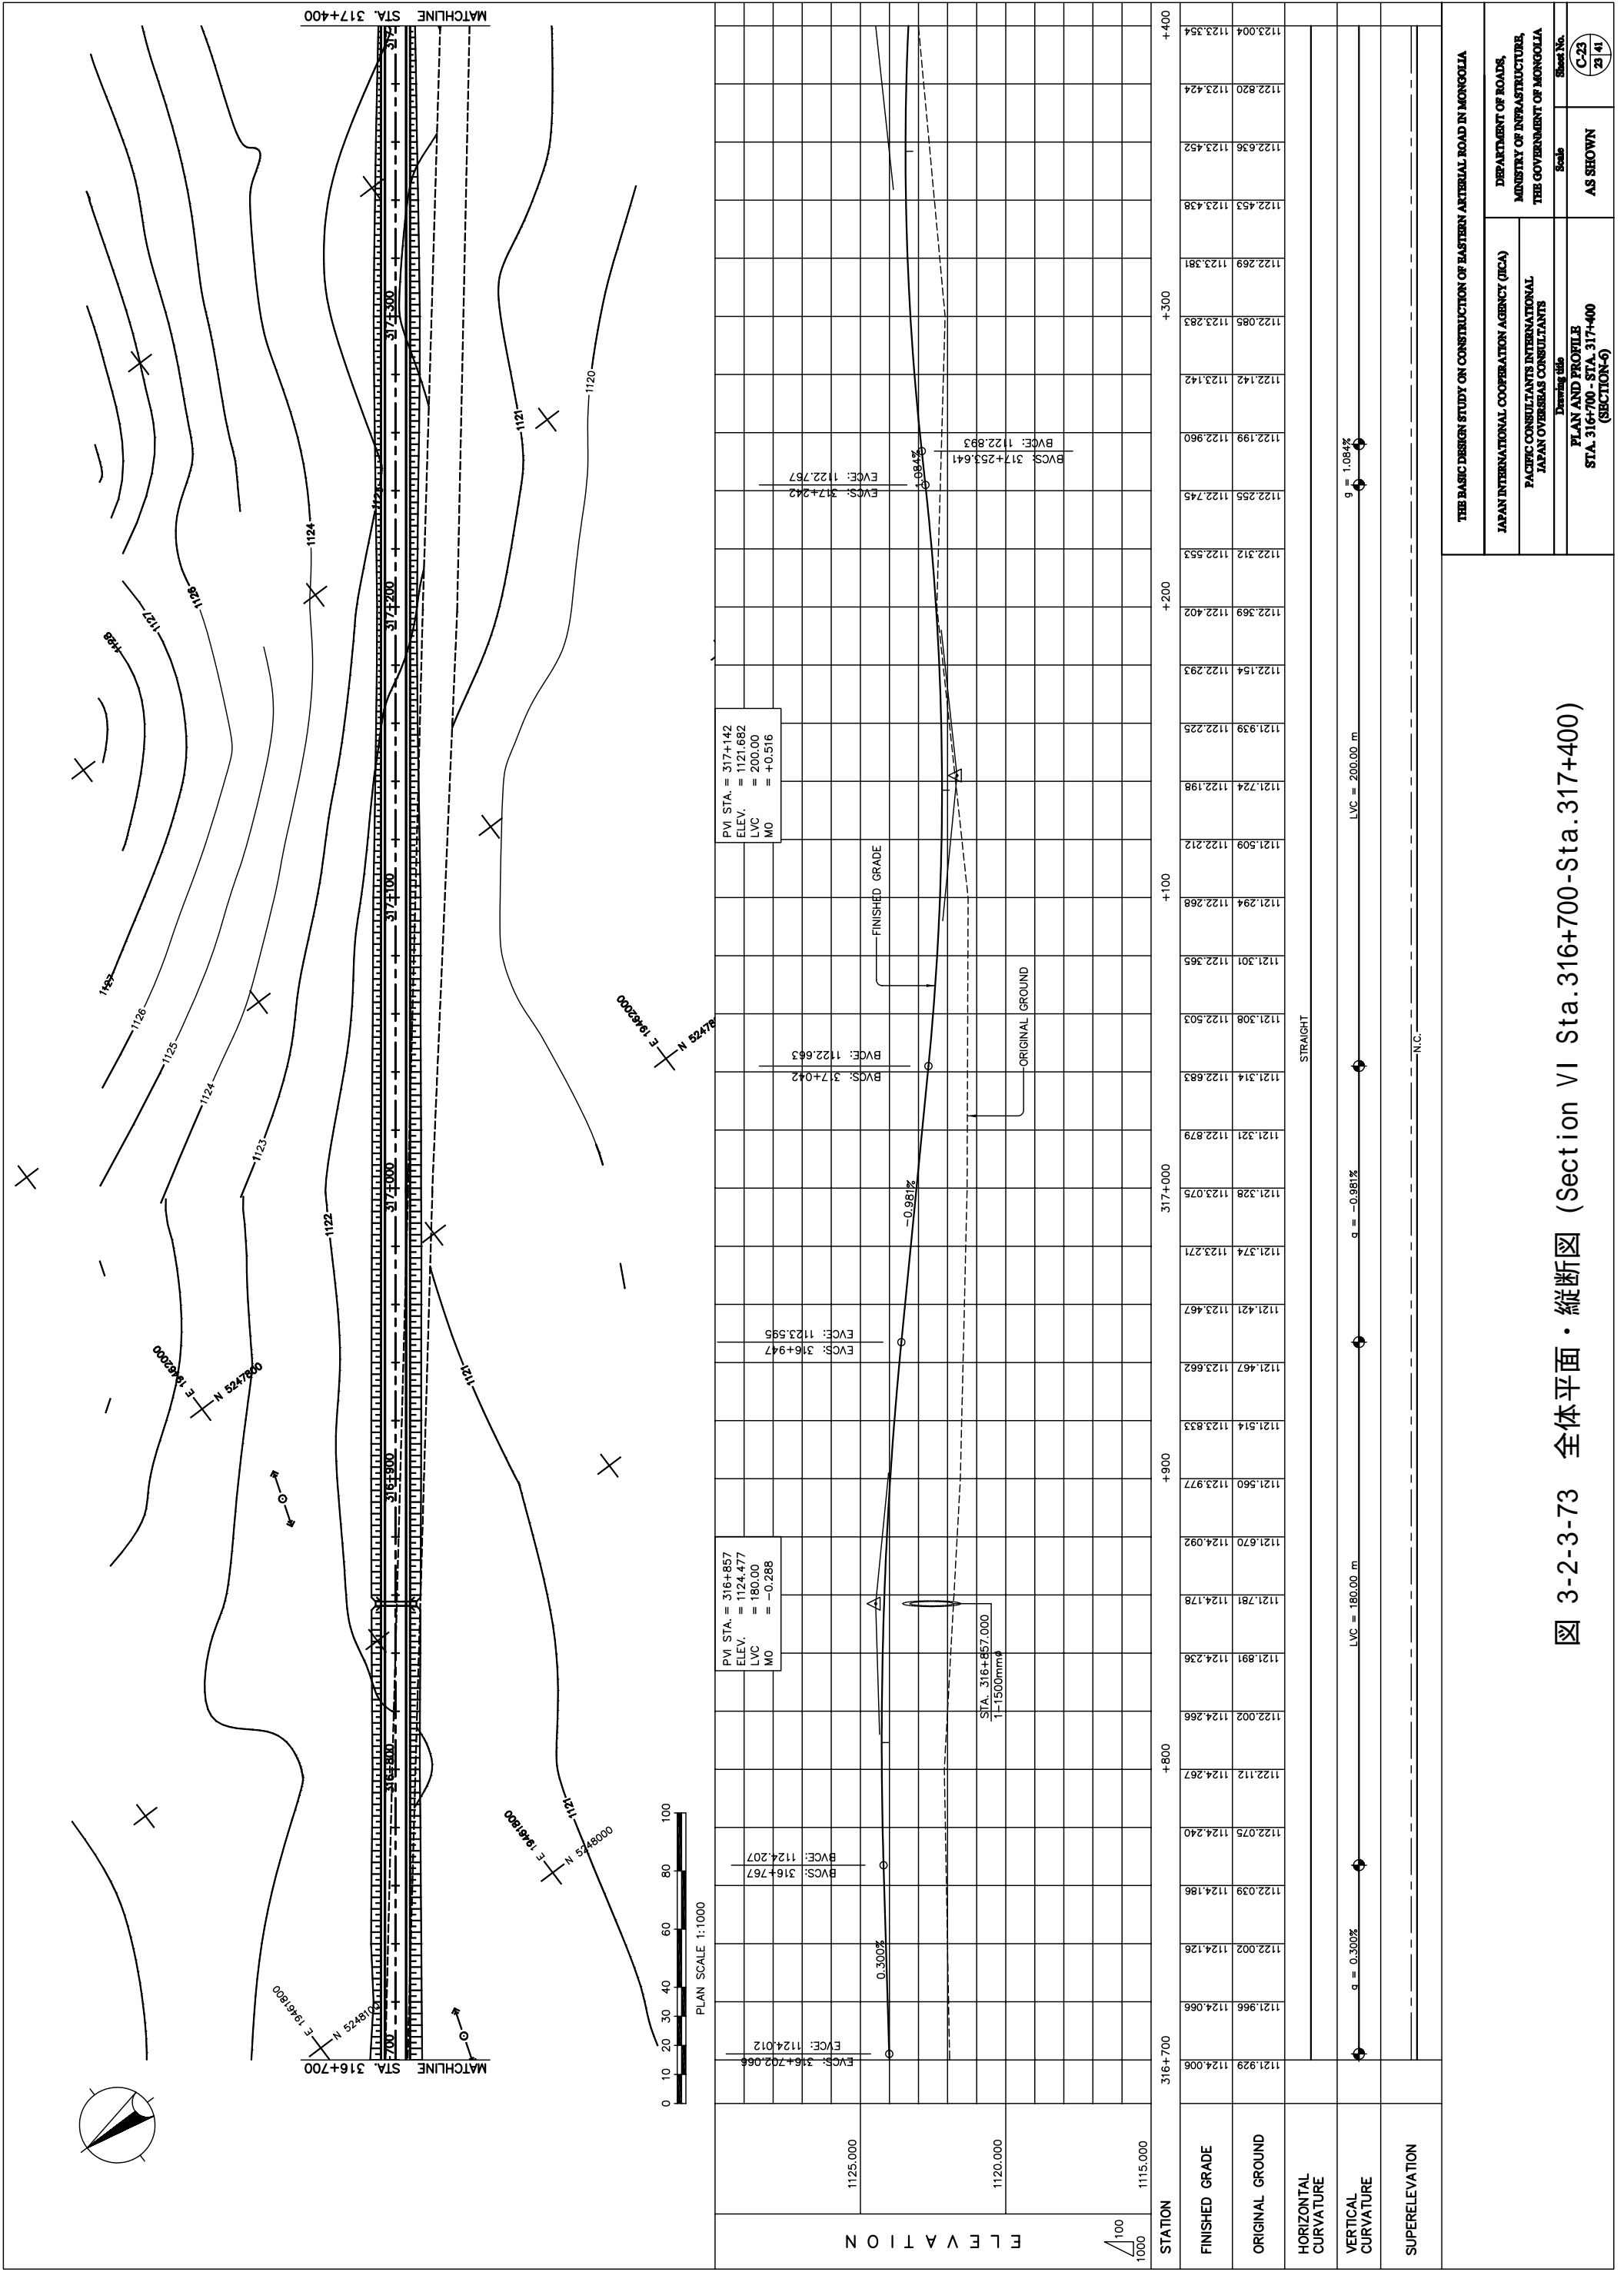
全体平面・縦断面図 (Section VI Sta. 316+700-Sta. 317+400)
